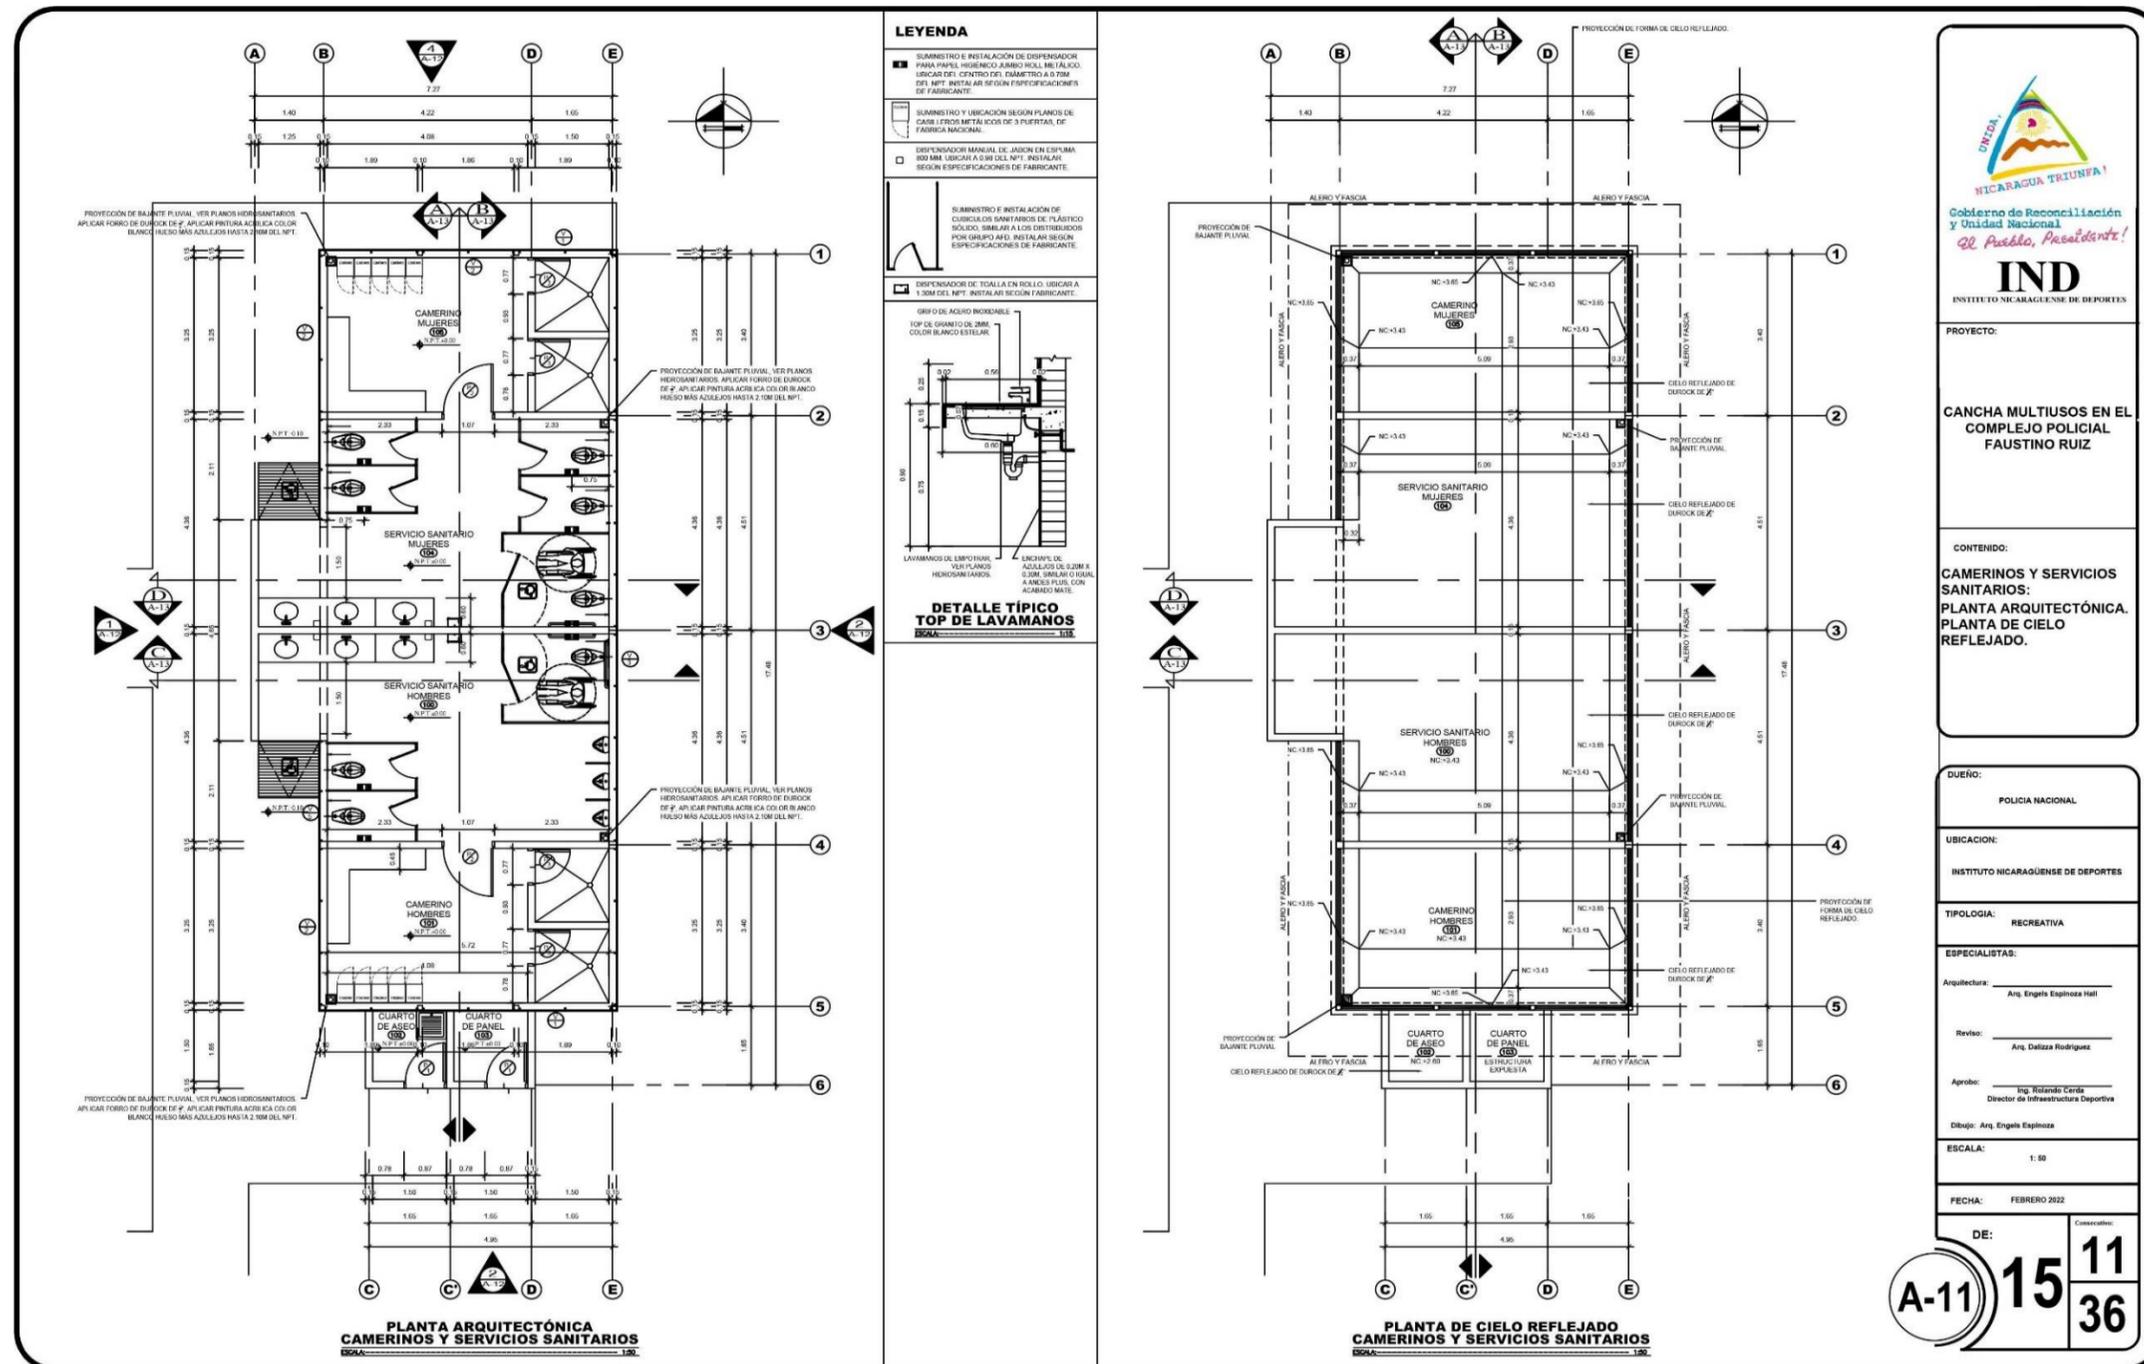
Planta arquitectónica finalizada de camerinos y servicios; Planta arquitectónica de cielo reflejado del proyecto de Cancha Multiusos Faustino Ruiz
